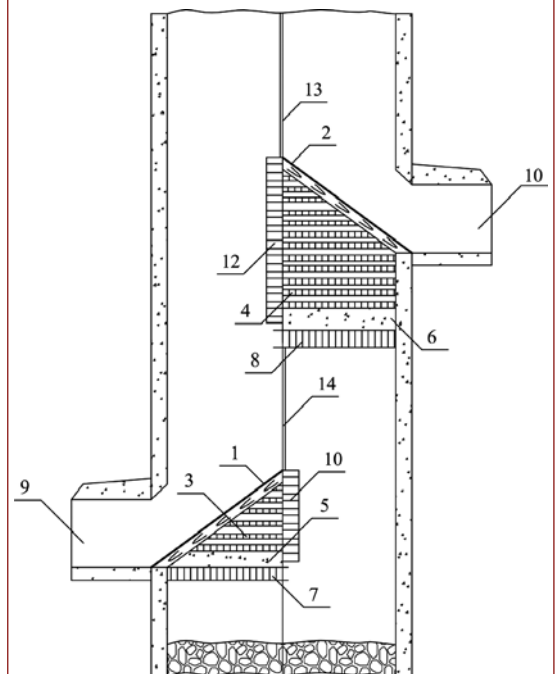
Клиновой предохранительный полк (Патент РФ №139338): 1, 2 — наклонная отражательная плоскость; 3, 4 — амортизирующий элемент; 5, 6 — распределительно-утяжелительная бетонная плита; 7, 8 — горизонтальные опорные балки; 9, 10 — отбойные ниши; 11, 12 — вертикальные стенки, состоящие из опорных балок; 13, 14 — разделительные стенки
